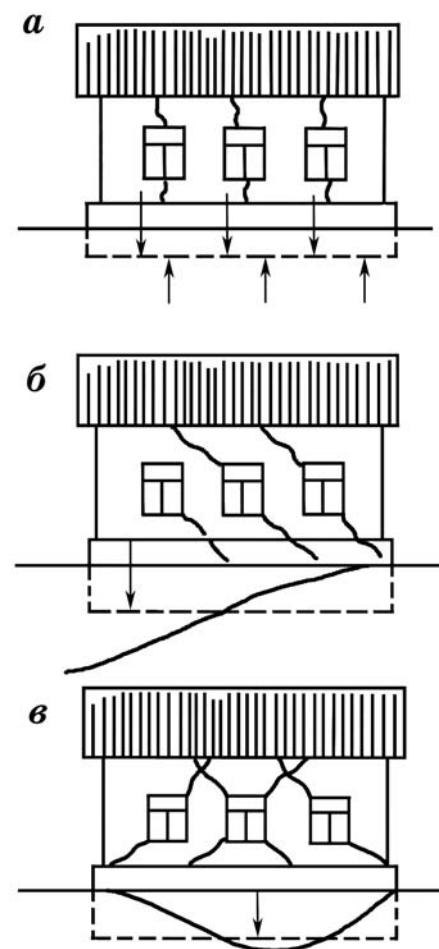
Деформации малоэтажных жилых зданий, возведенных на просадочных грунтах, от физико-механических явлений и сейсмика:
